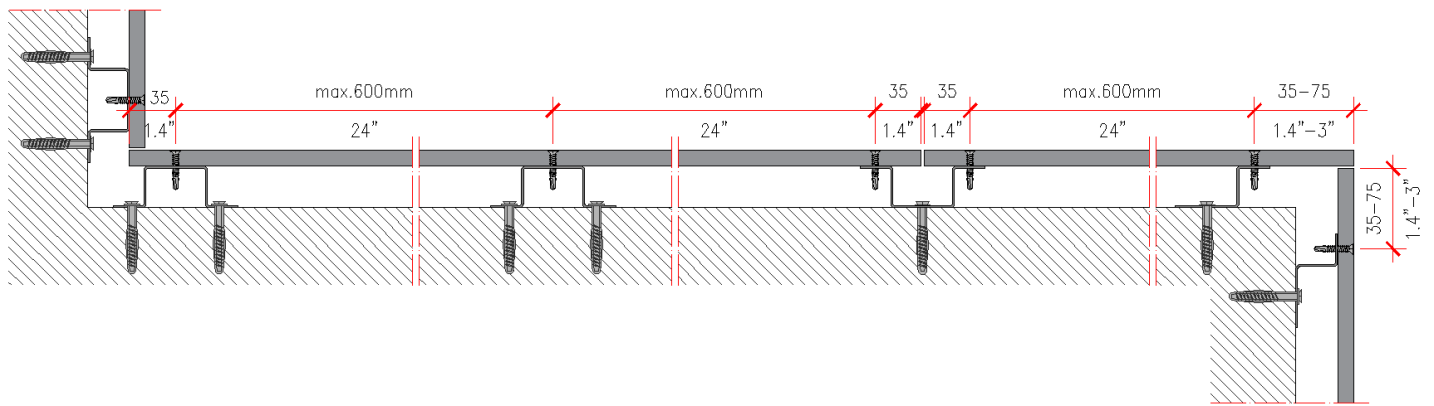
Section horizontale du revêtement mural, structure en acier galvanisé
